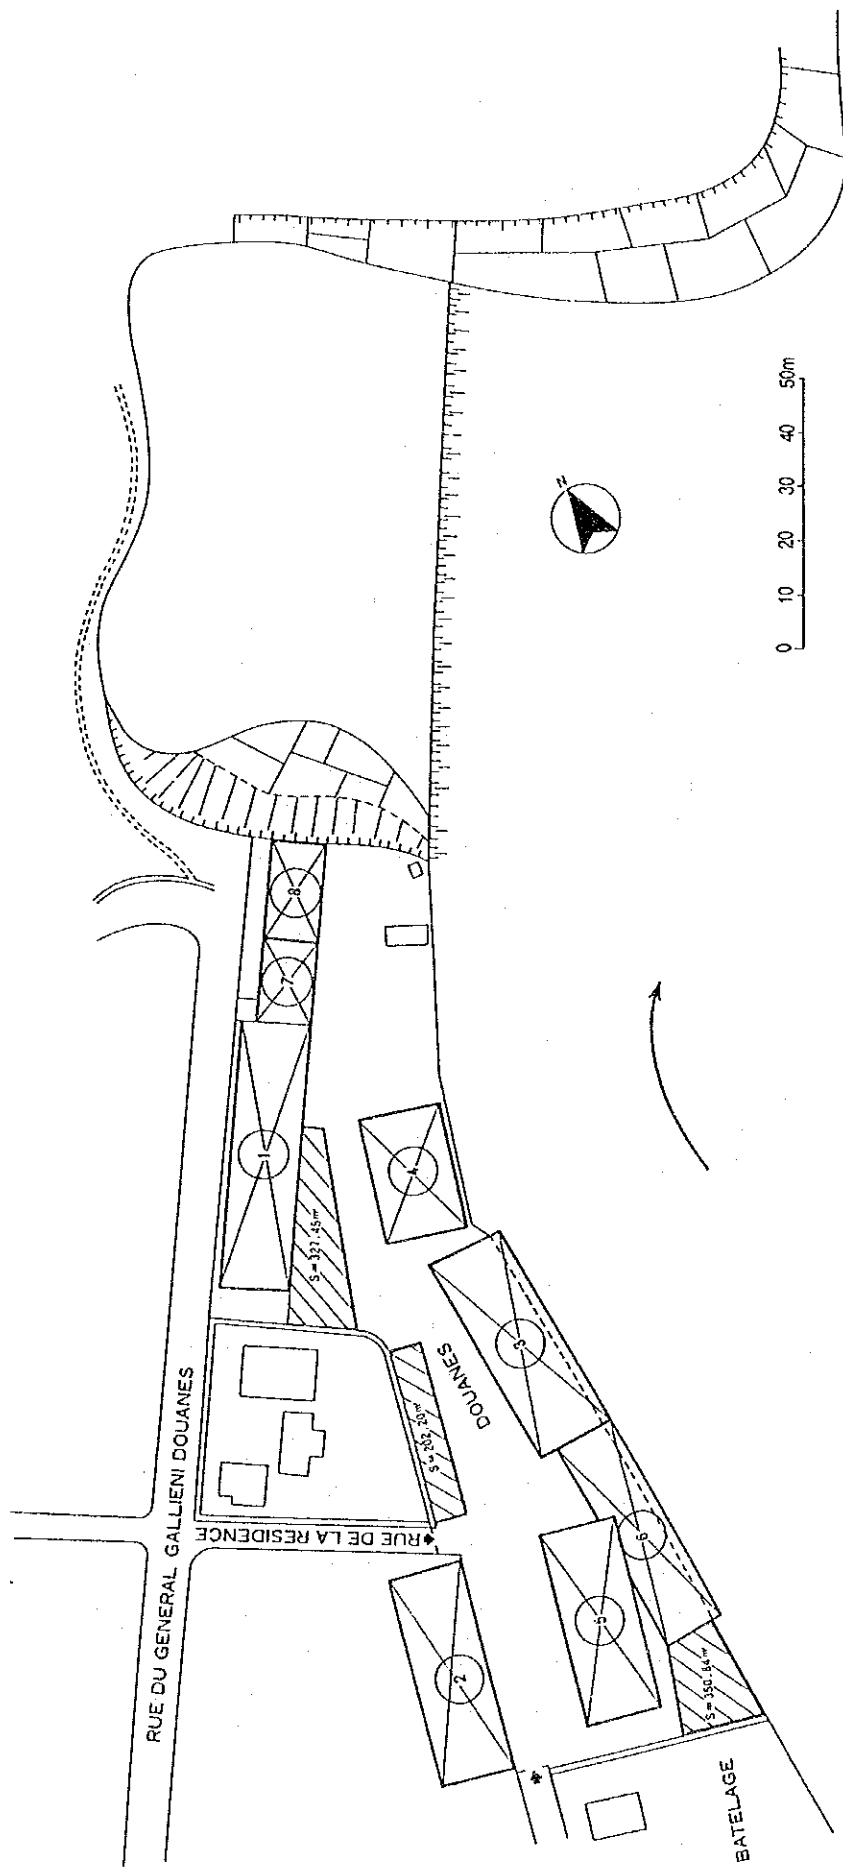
Plan d'implantation du Port de MANANJARY
